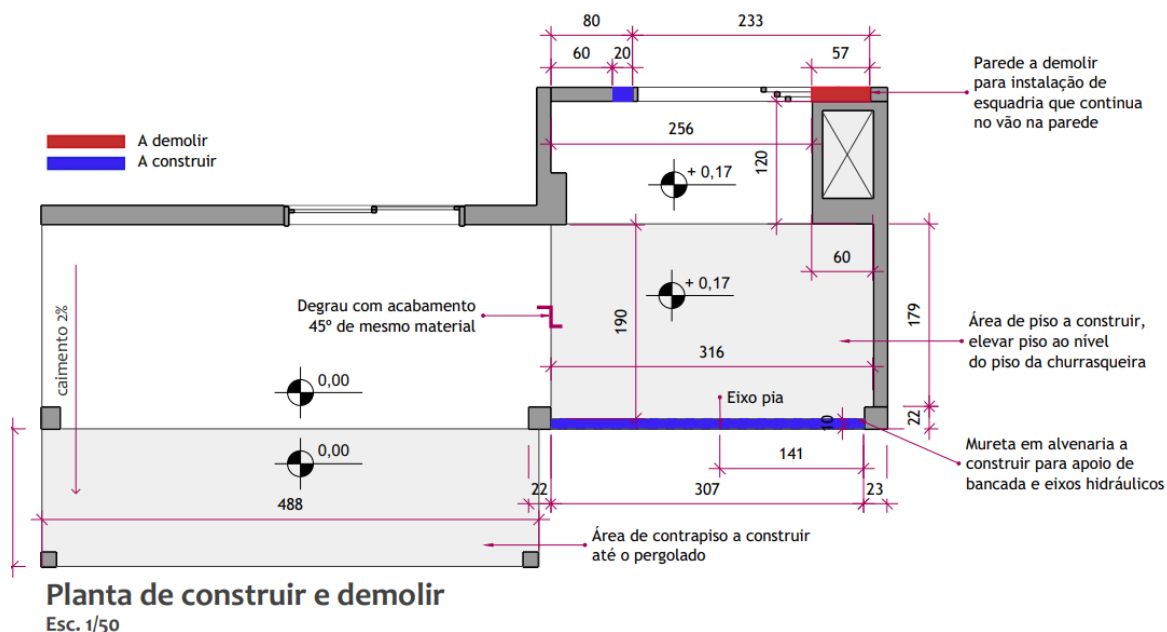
Planta de construir e demolir (Estudo de Caso A)
